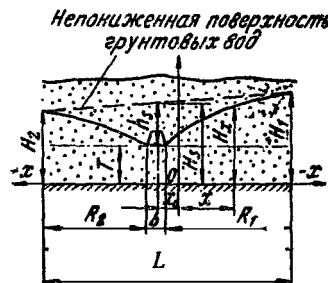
Схема к расчету длинной прямолинейной горизонтальной дрены, расположенной выше подошвы безнапорного пласта на неодинаковых расстояниях от границ питания и стока
